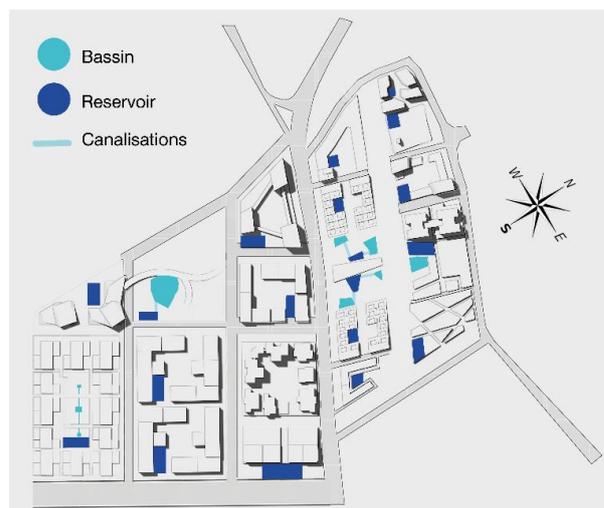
schéma de collection des eaux pluviales. Source : travail d'auteur
